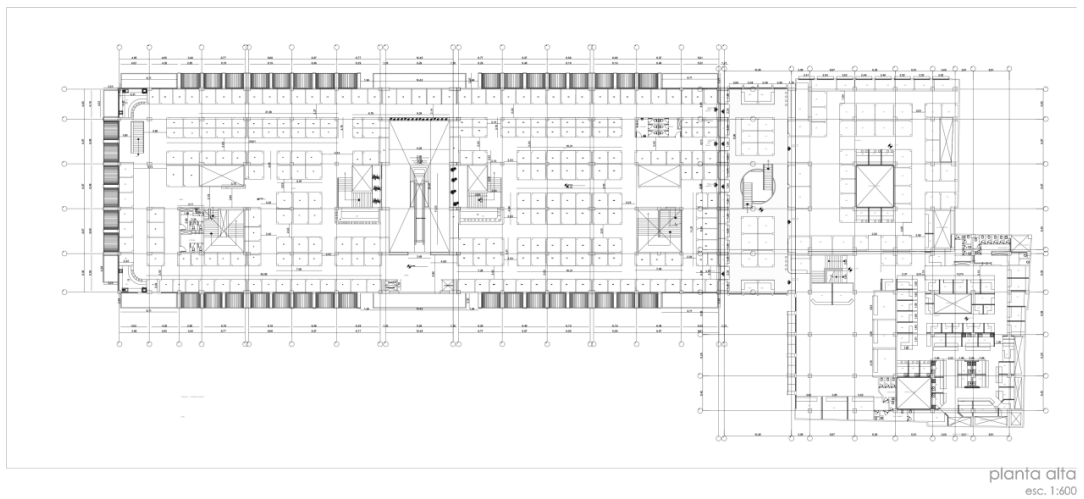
Estado actual planta alta. (Bustamante, 2018).
